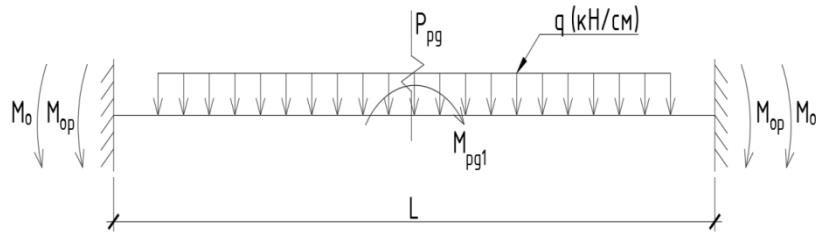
Расчетная схема и нагрузки на предварительно напряженную балку, жестко закрепленную на опорах
